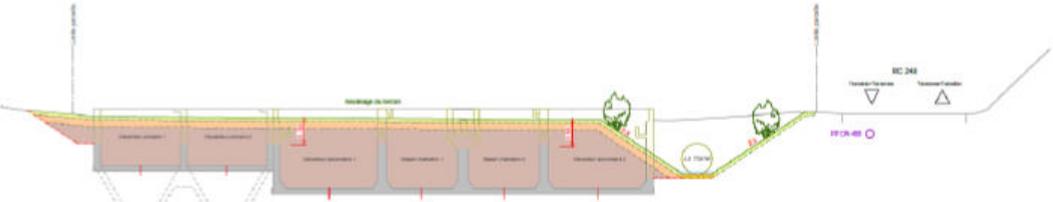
extrait plan d'avant-projet du bureau ATB pour la transformation de la STEP de Tramelan
